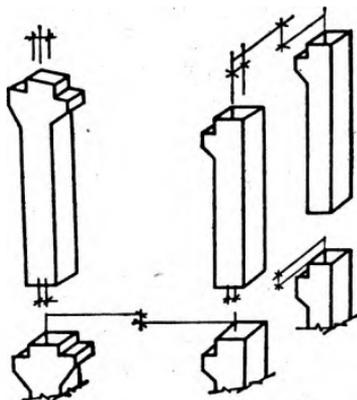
Контролируемые параметры при монтаже железобетонных колонн многоэтажных зданий
